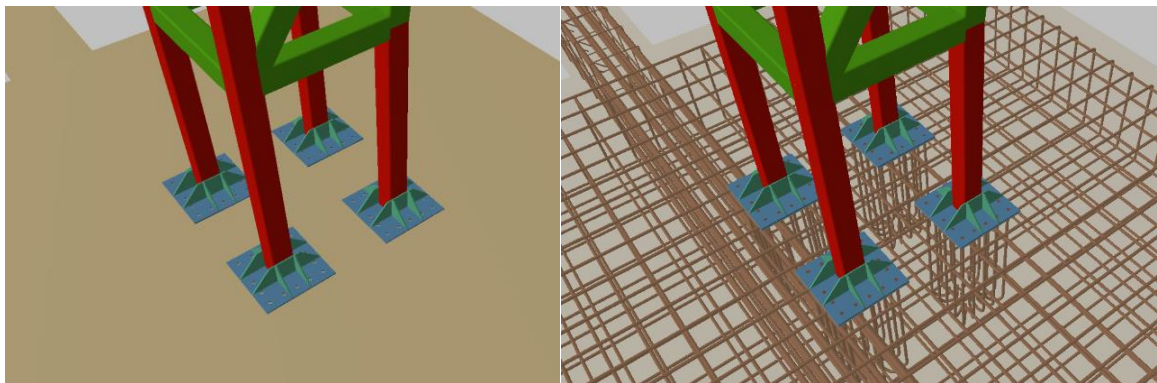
| Vista de elementos estructurales a partir de anclajes
